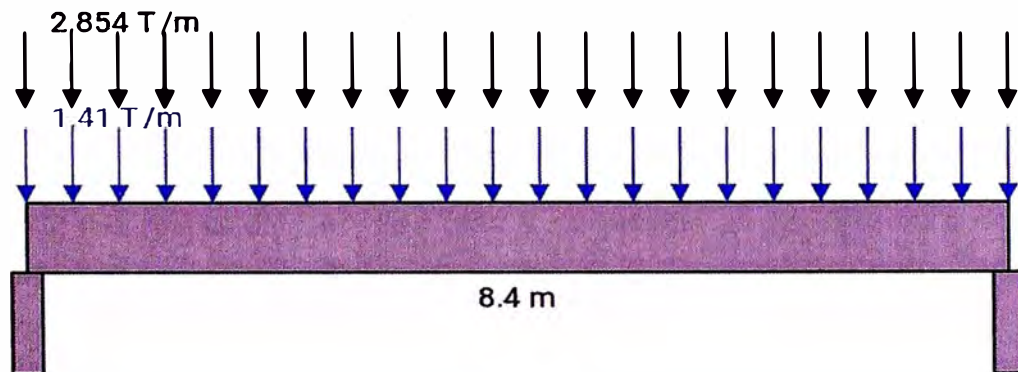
Datos ingresados al aplicativo móvil de la viga V-100.
